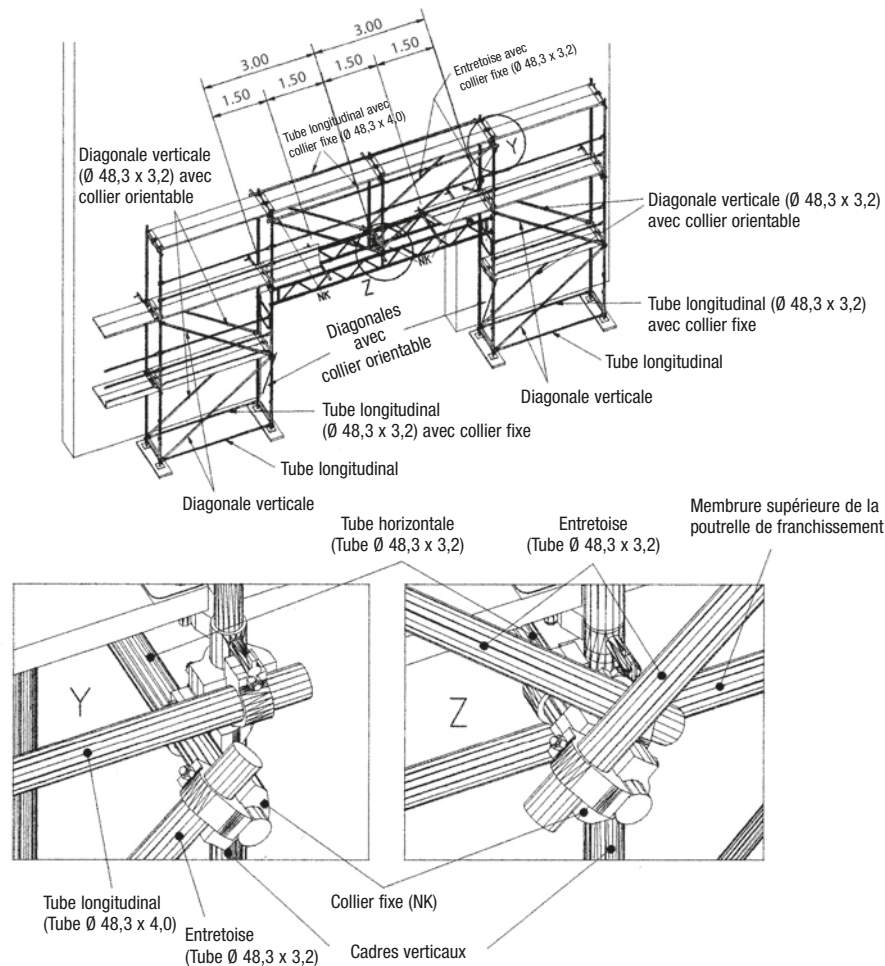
Montage avec entretoise; renforcement de la membrure supérieure par ancrage dans la façade ou par moise horizontale.
